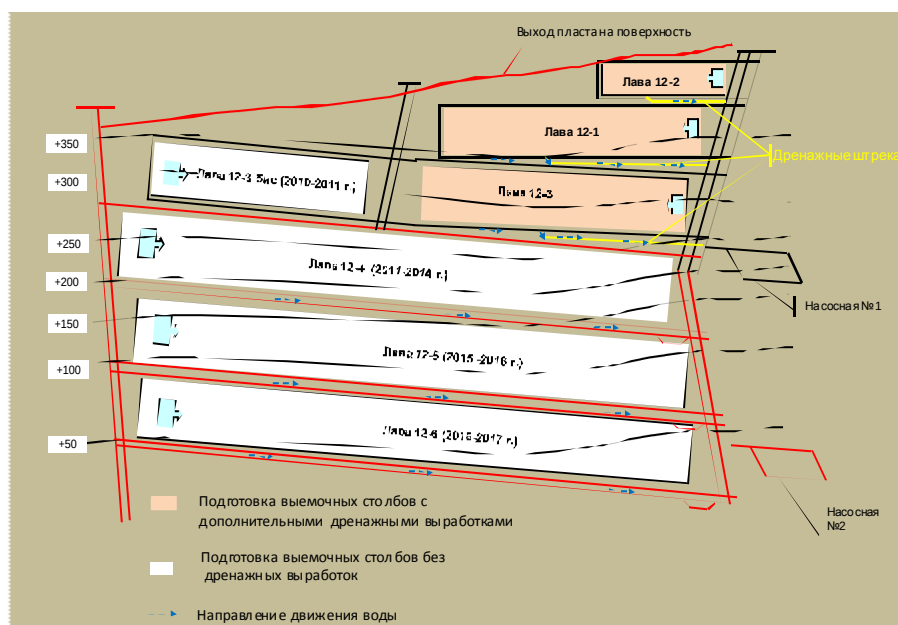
Схема вскрытия пл. В-12 наклонными стволами с отработкой длинными столбами по простиранию (шахта «Северная» ОАО «Ургалуголь»)
